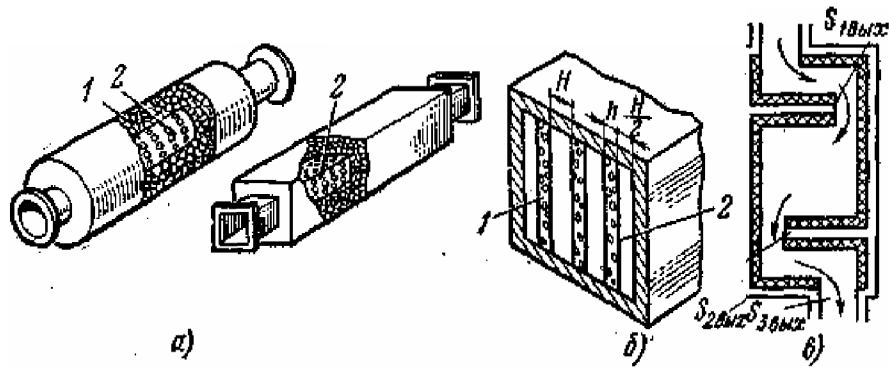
Схемы глушителей. 1 – звукопоглощающий материал; 2 – сетка или перфорированная оболочка;
